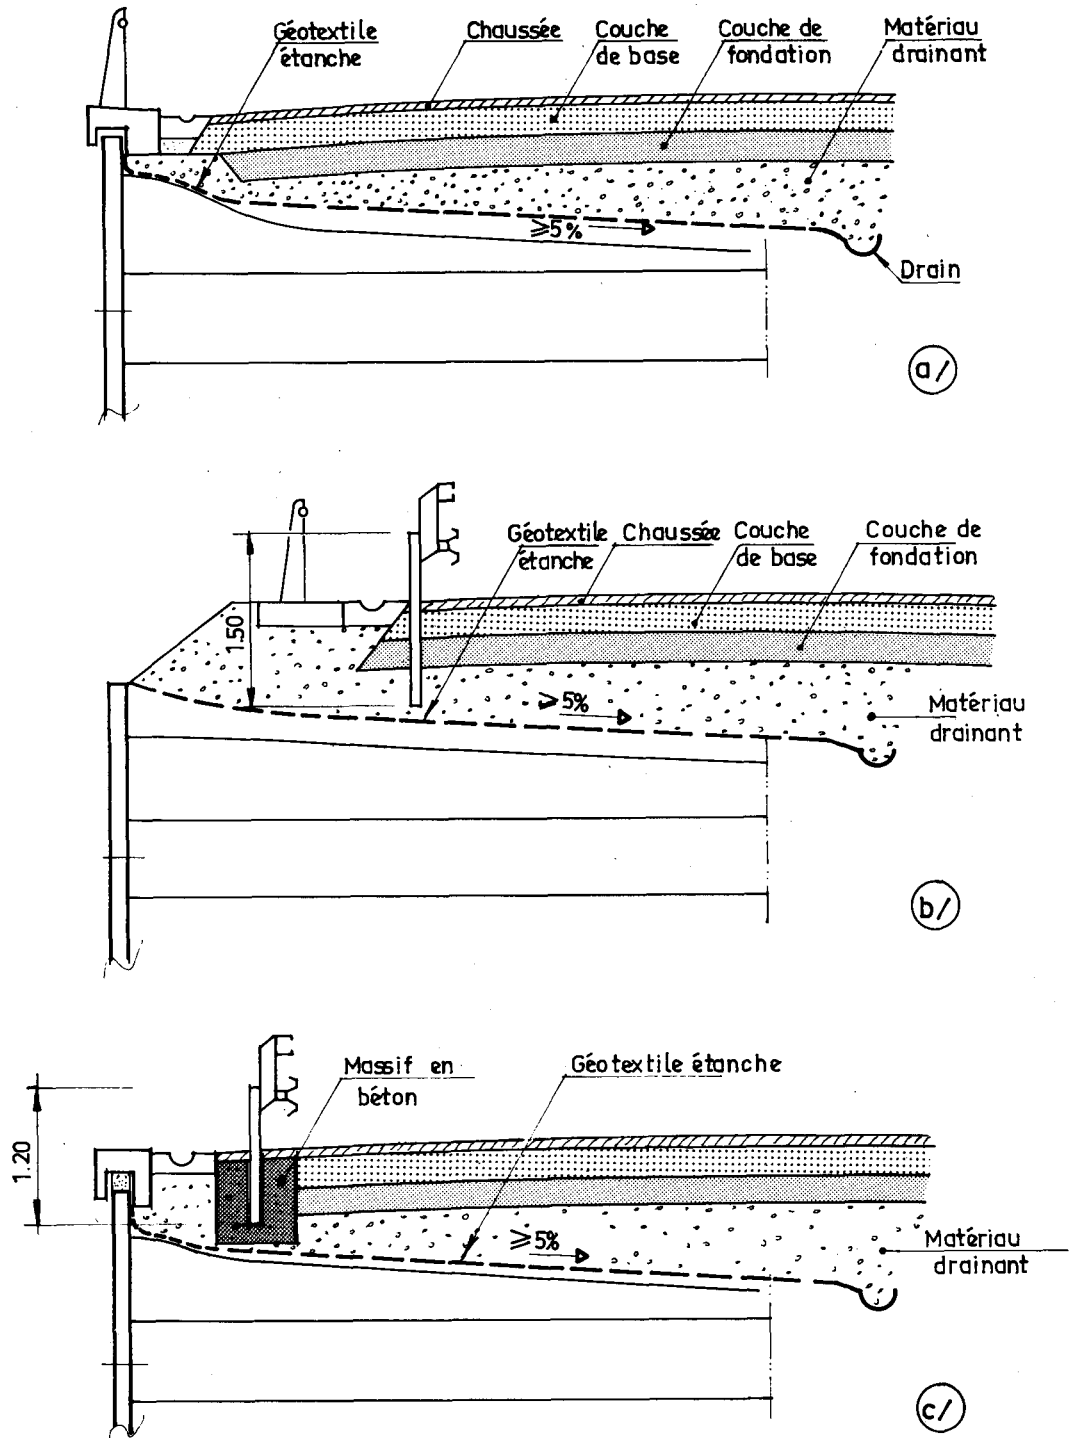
Exemples de protection sous chaussée contre les eaux de ruissellement.
